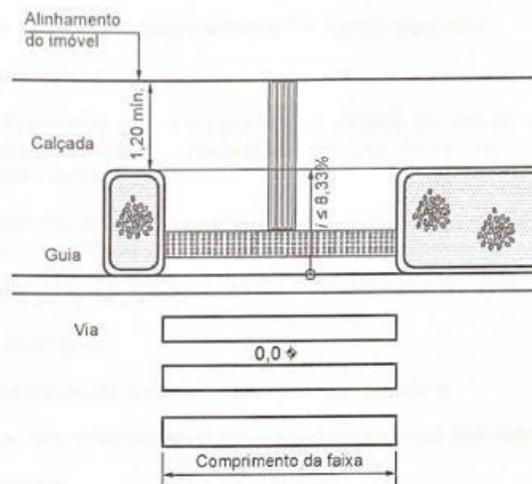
Rebaixamentos de calçada entre canteiros – Vista superior
